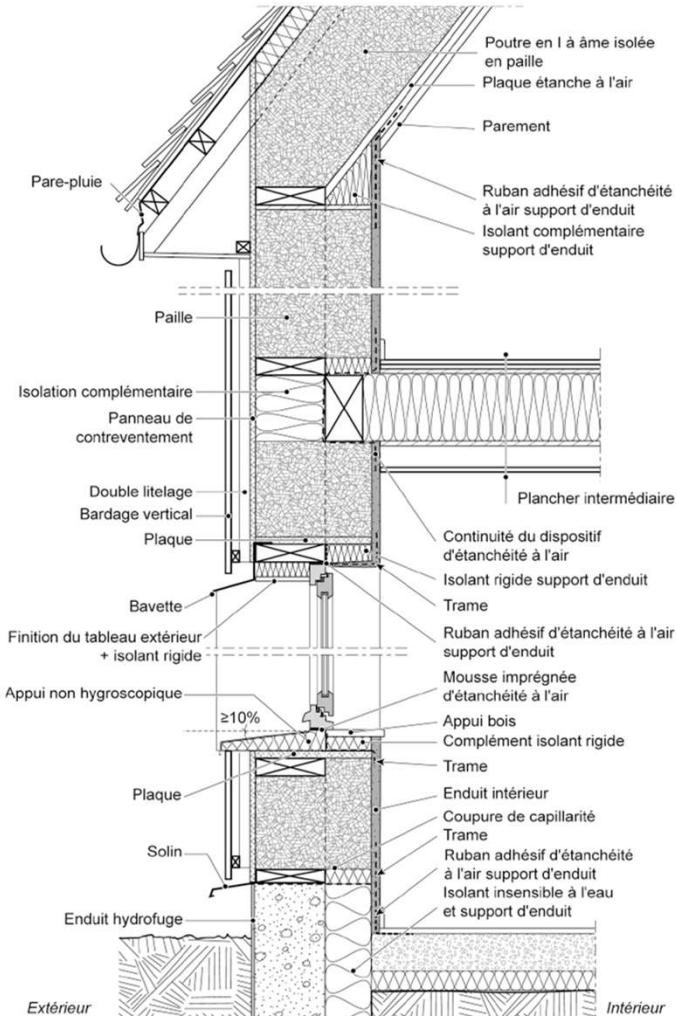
Exemple de coupe verticale d'une paroi avec ossature simple désaxée vers l'extérieur
